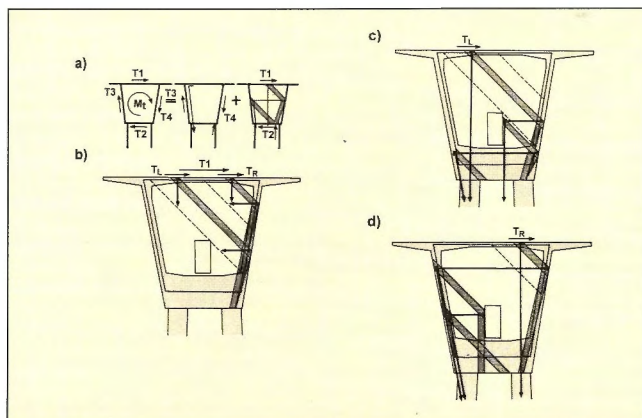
Přenos normálových napětí do rámových rohů komorového průřezu:
